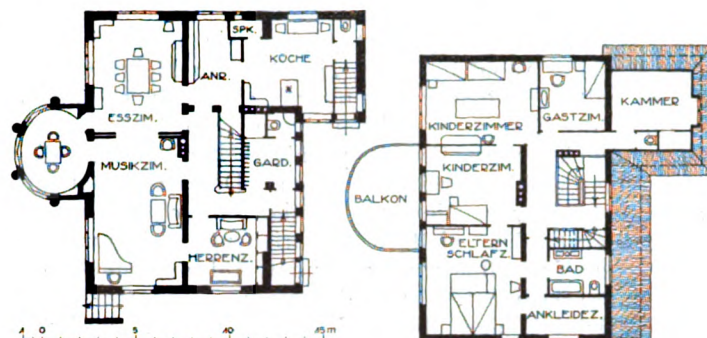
bis 16. Haus Pfefferkorn. Lageplan 1:1000, Grundrisse 1:400.
